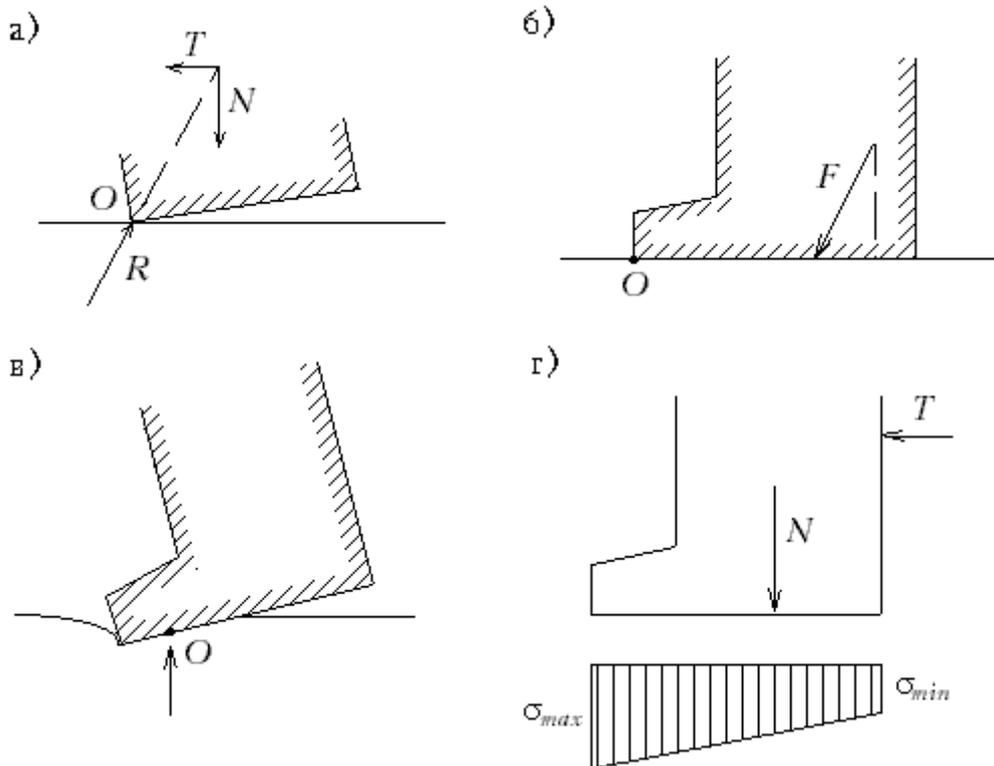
Схема для расчета устойчивости на опрокидывание:
